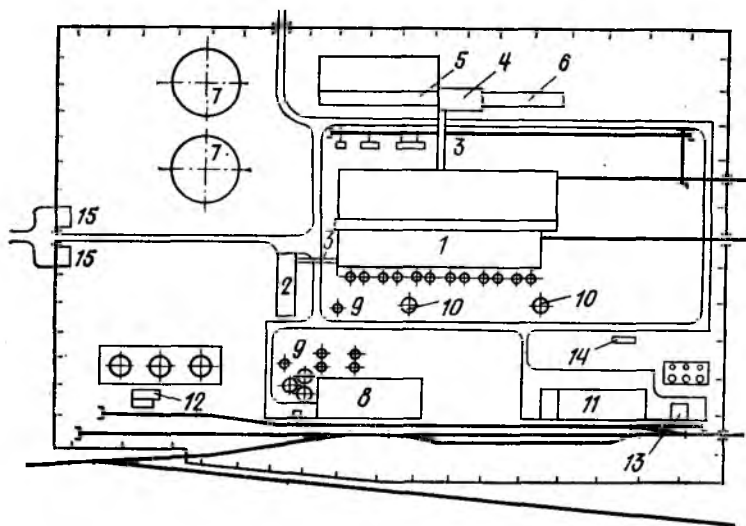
Схема генерального плана ТЭЦ на мазуте:
